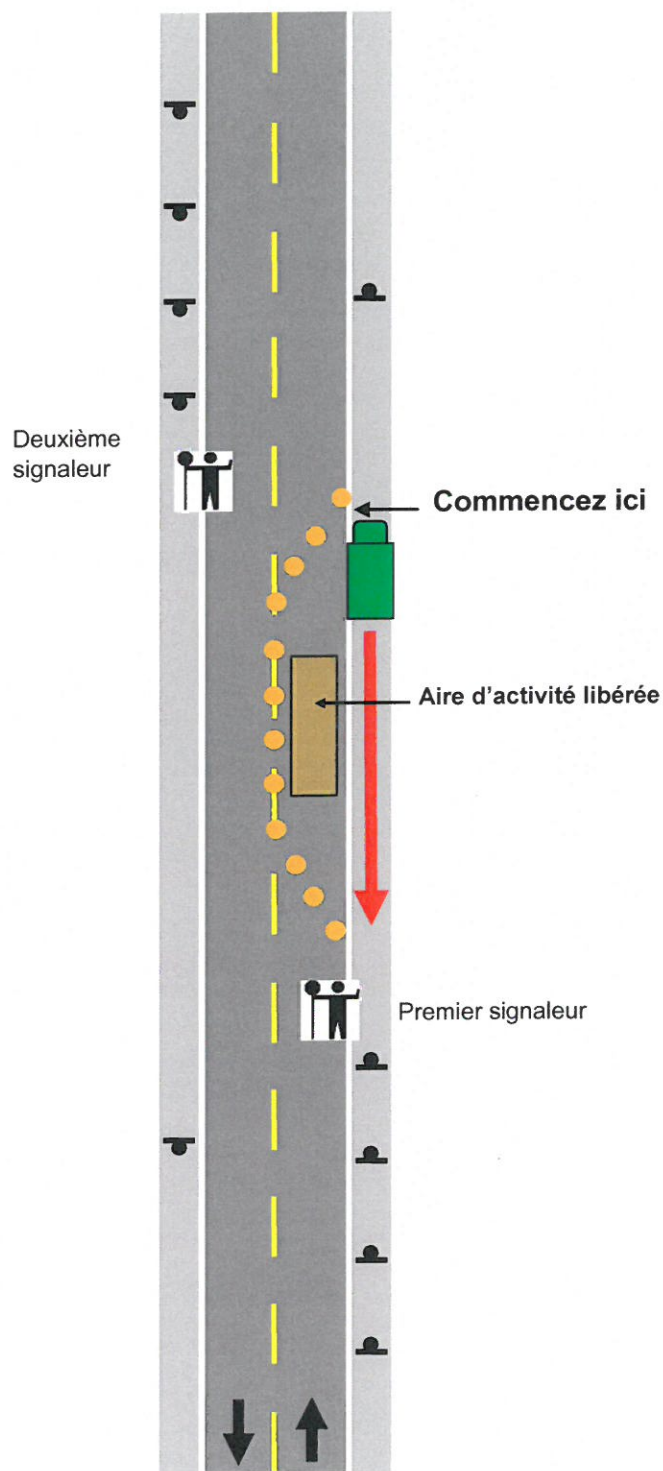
Enlèvement pour la fermeture d'une voie (routes à deux voies)
